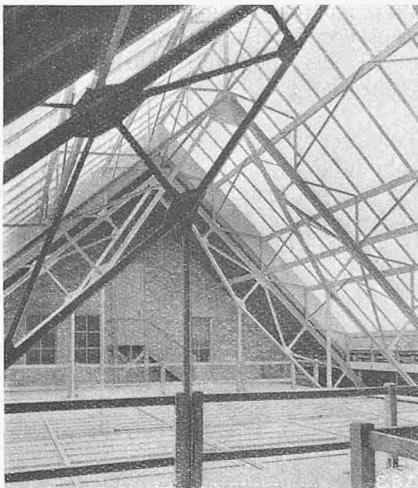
Dachkonstruktion mit Oberlicht über dem Schaltstand.
